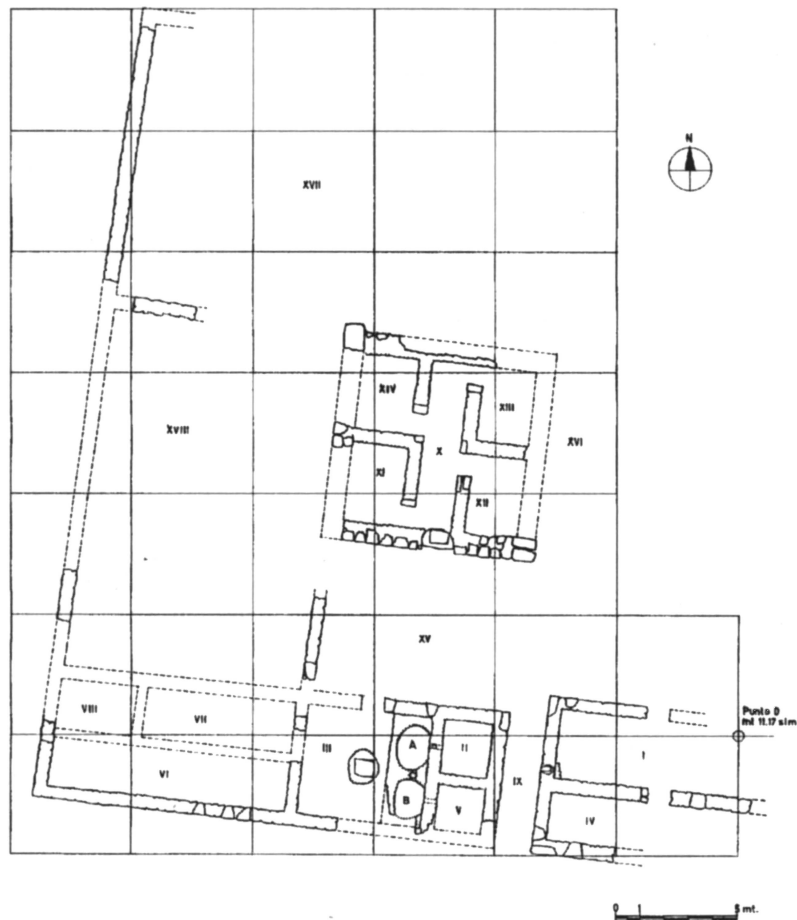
Planimetria dello stabilimento rurale di S'Imbalconadu (da Sanciu 1997).
